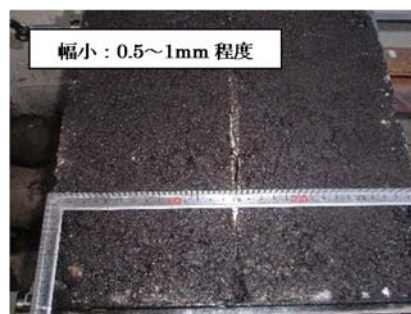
曲げ破断によるひび割れの作製状況
